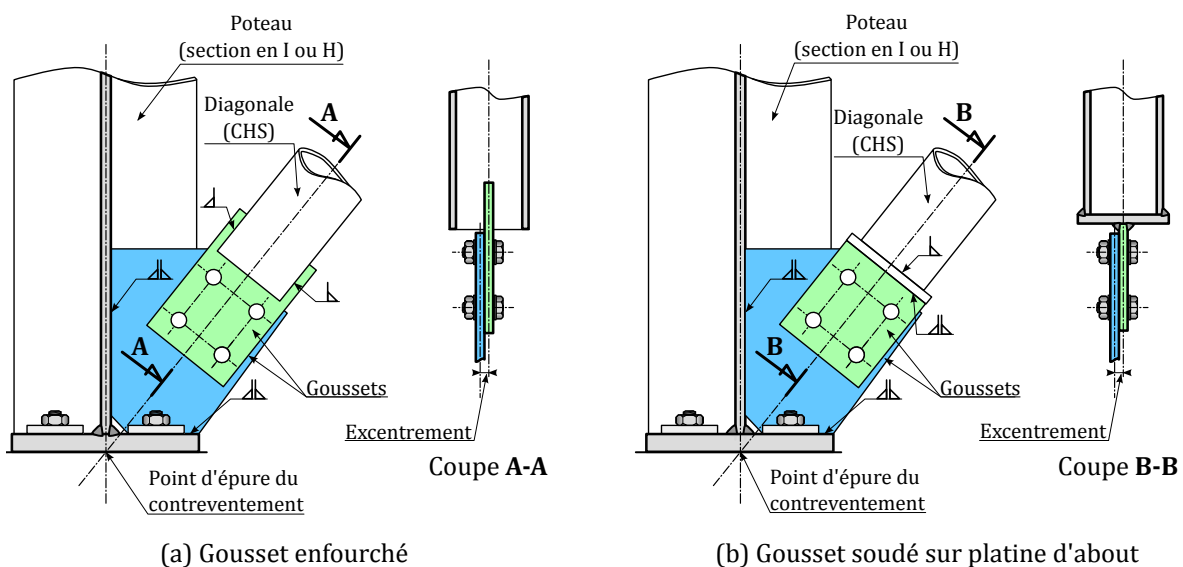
Assemblage d'un profil creux par gousset – Dispositions de base
